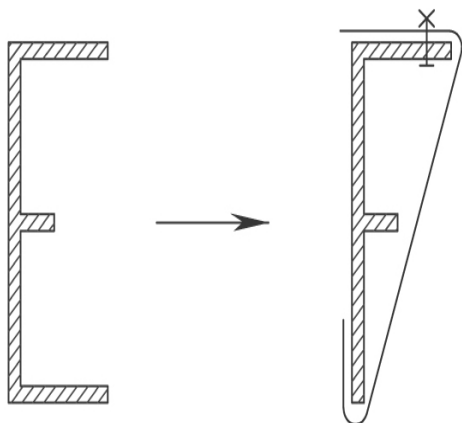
Изготовление сегмента режущего башмака из тьюбинга.
